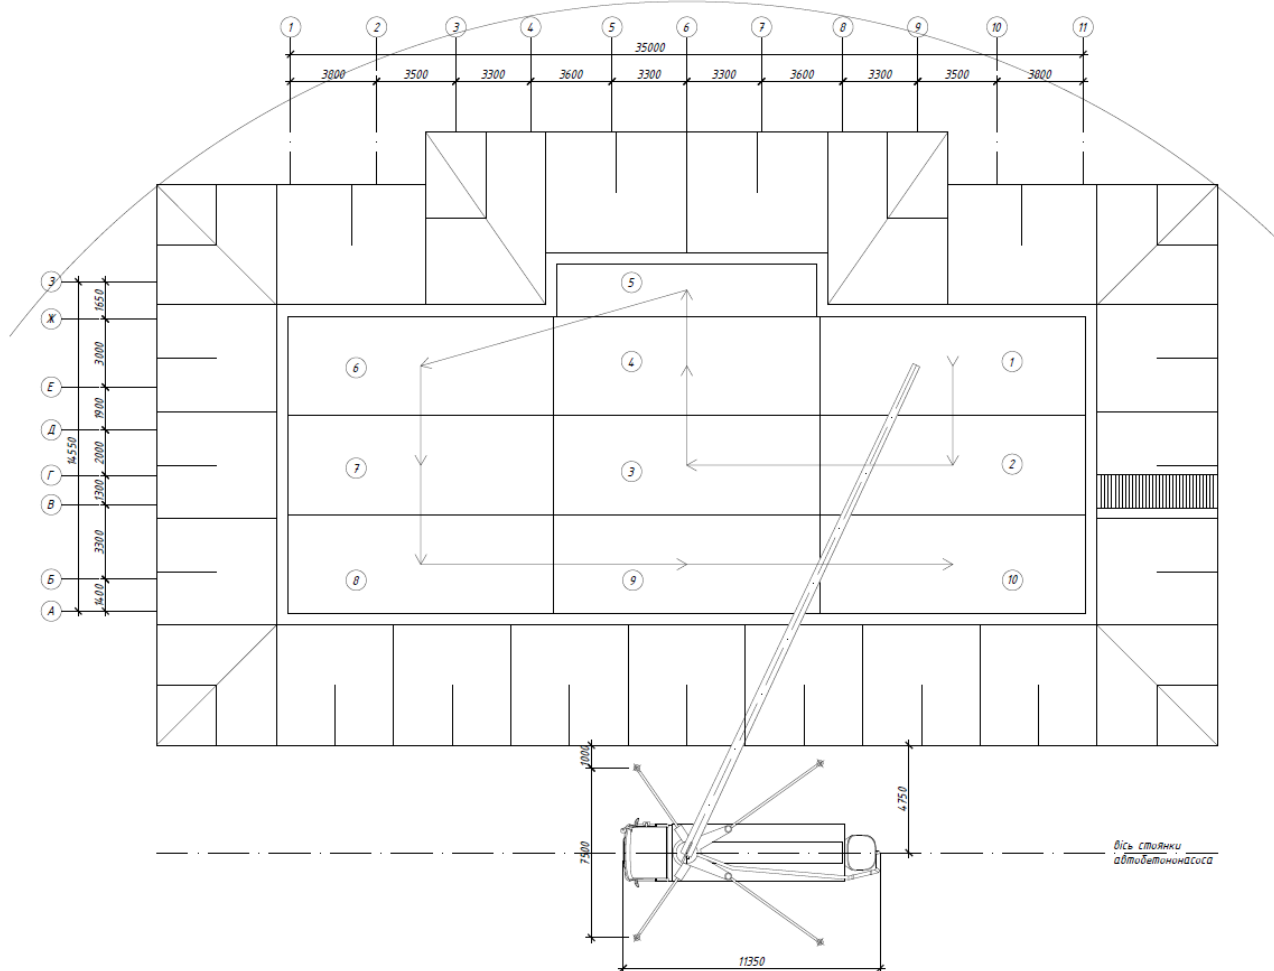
Схема бетонування монолітної залізобетонної фундаментної плити
